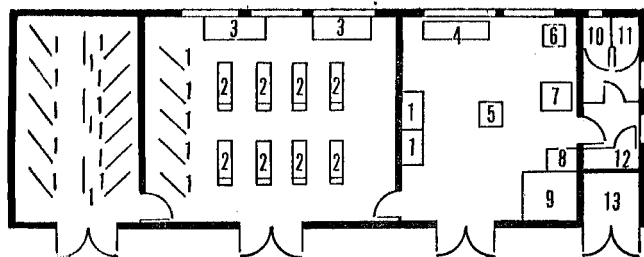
Планировка помещений мотосекции: 1 — места хранения мотоциклов; 2 — мотоверстаки; 3 — слесарные верстаки; 4 — токарный станок; 5 — сверлильный станок; 6 — тошльный станок; 7 — фрезерный станок; 8 — гидравлический пресс; 9 — сварочный пост; 10 — душевая; 11 — сушилка; 12 — туалет; 13 — мойка
